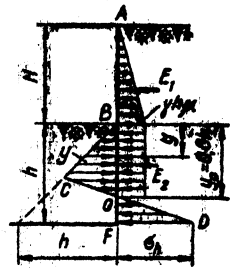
Расчетная схема тонкой подпорной стенки.
